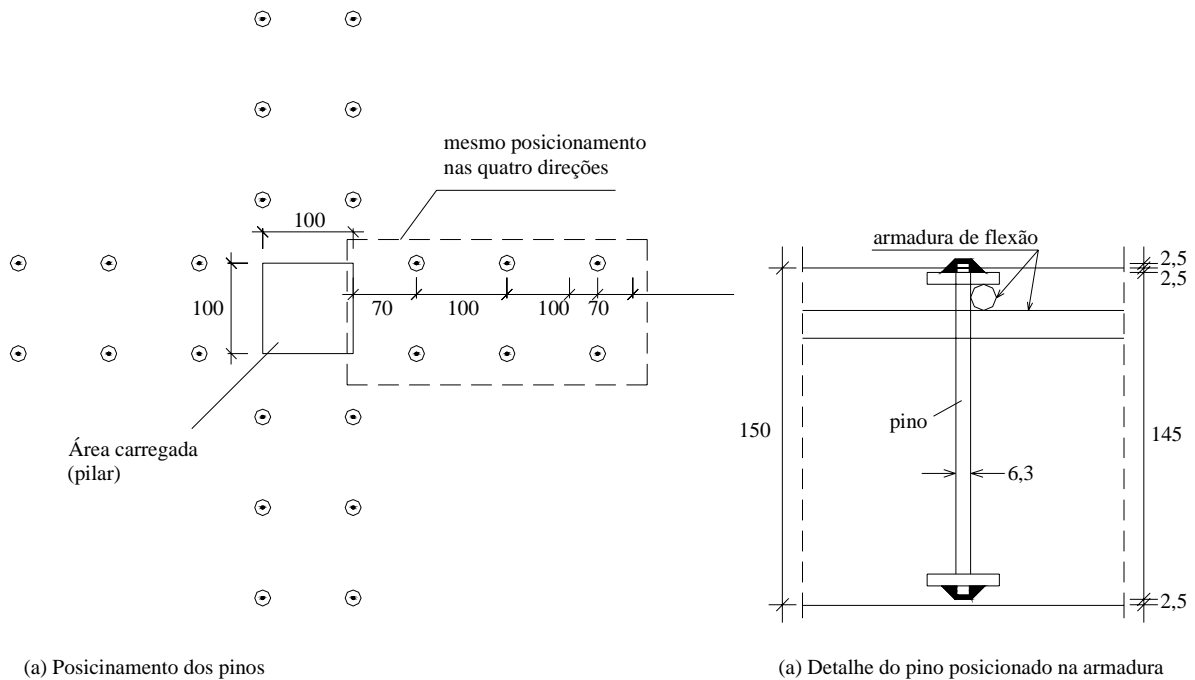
Armadura de cisalhamento utilizada nas lajes 8 e 11 (mm)
